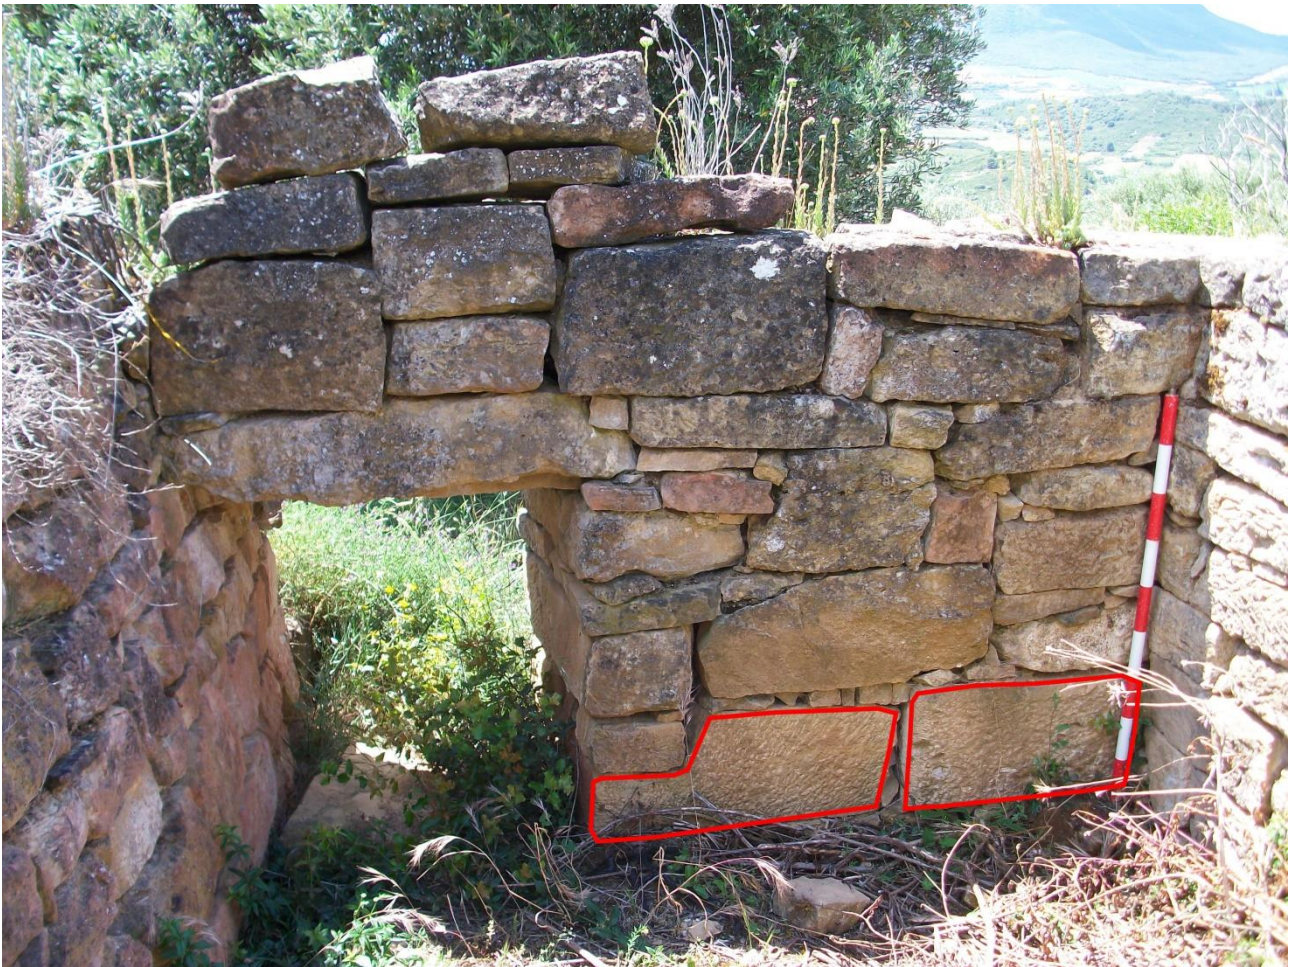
Cara interna del muro sur del guardaviñas. Hemos delimitado en rojo los dos sillares trabajados del fuerte que, fueron reutilizados para la construcción del edificio tras la guerra
